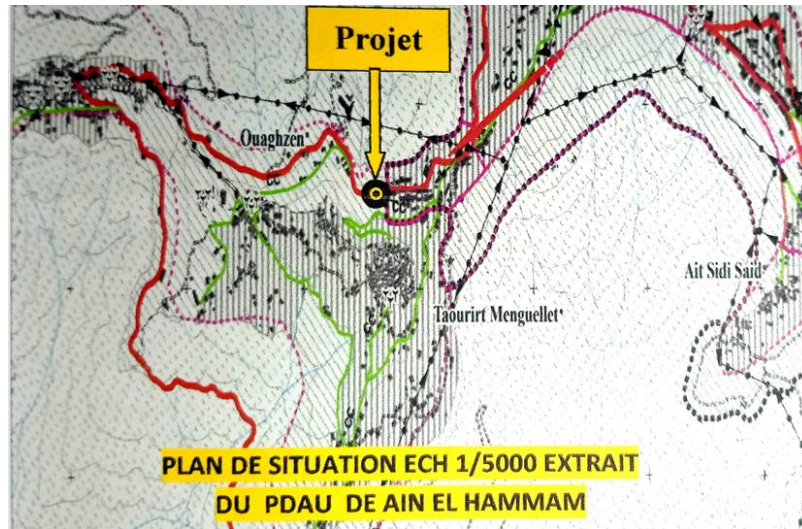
Plan de situation Ech 1/5000 extrait du PDAU Ain El Hammam.
